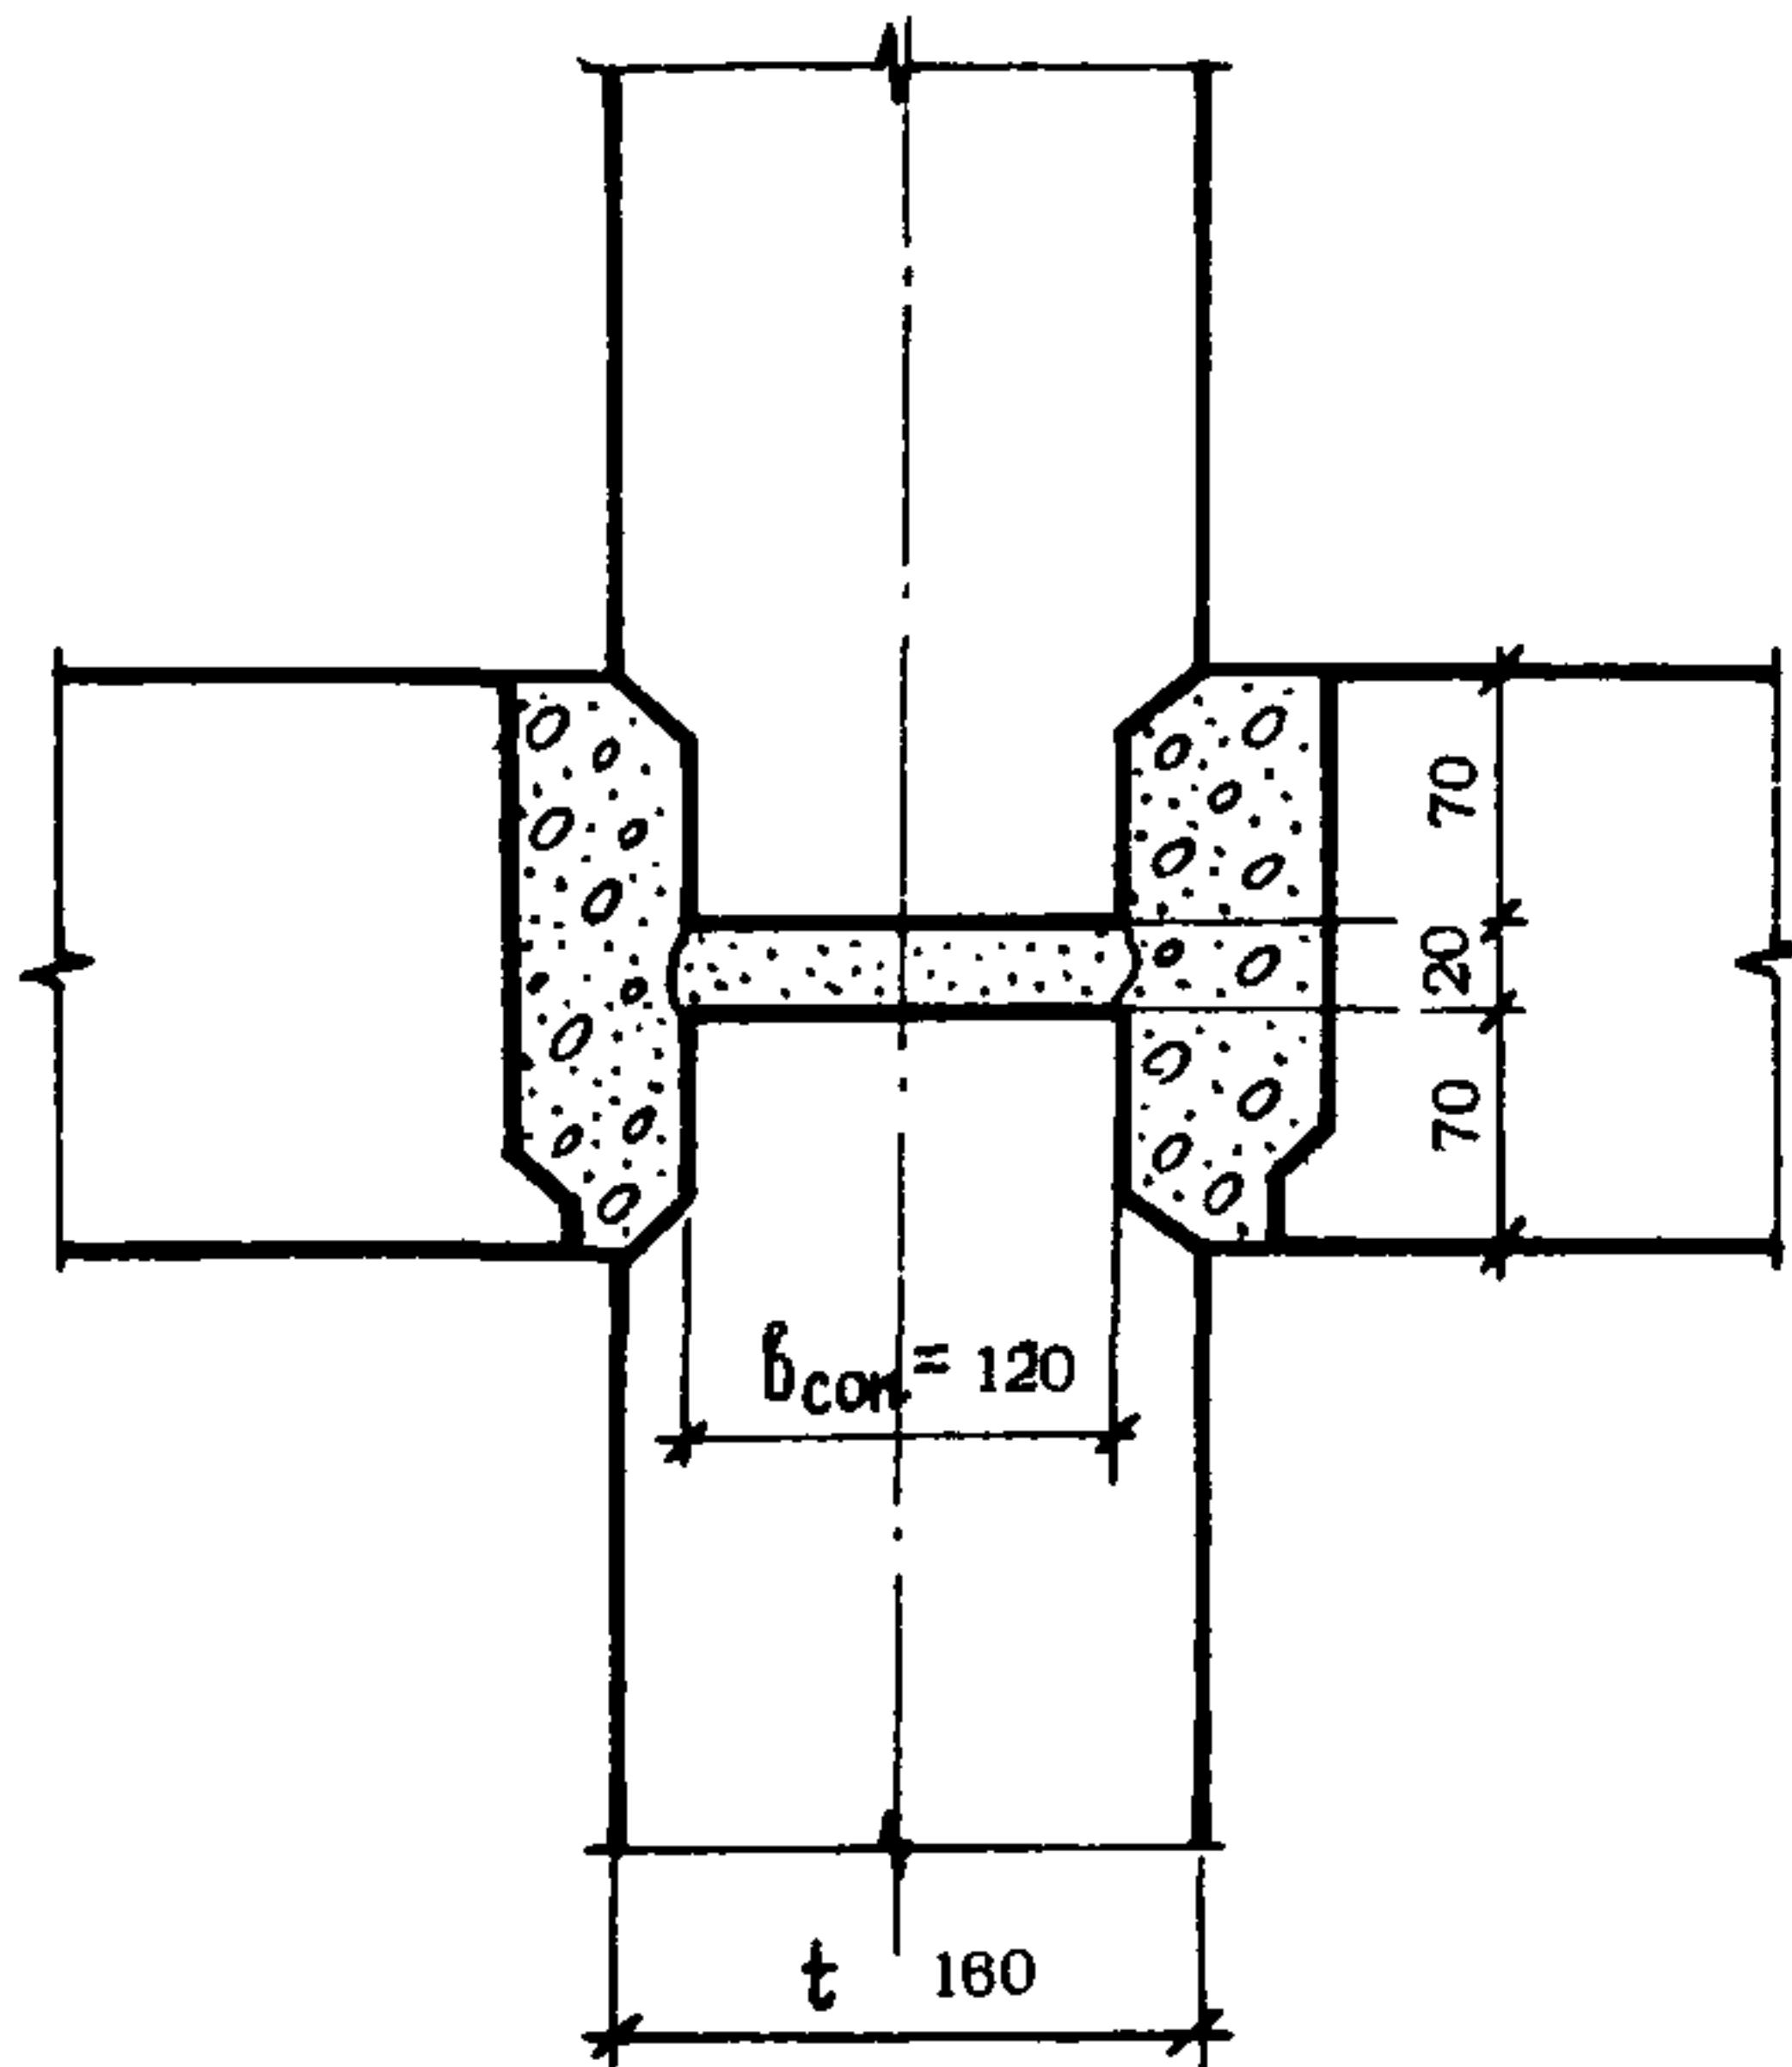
Контактный стык внутренней панельной стены при двустороннем опирании плит перекрытий (к примеру 7)
